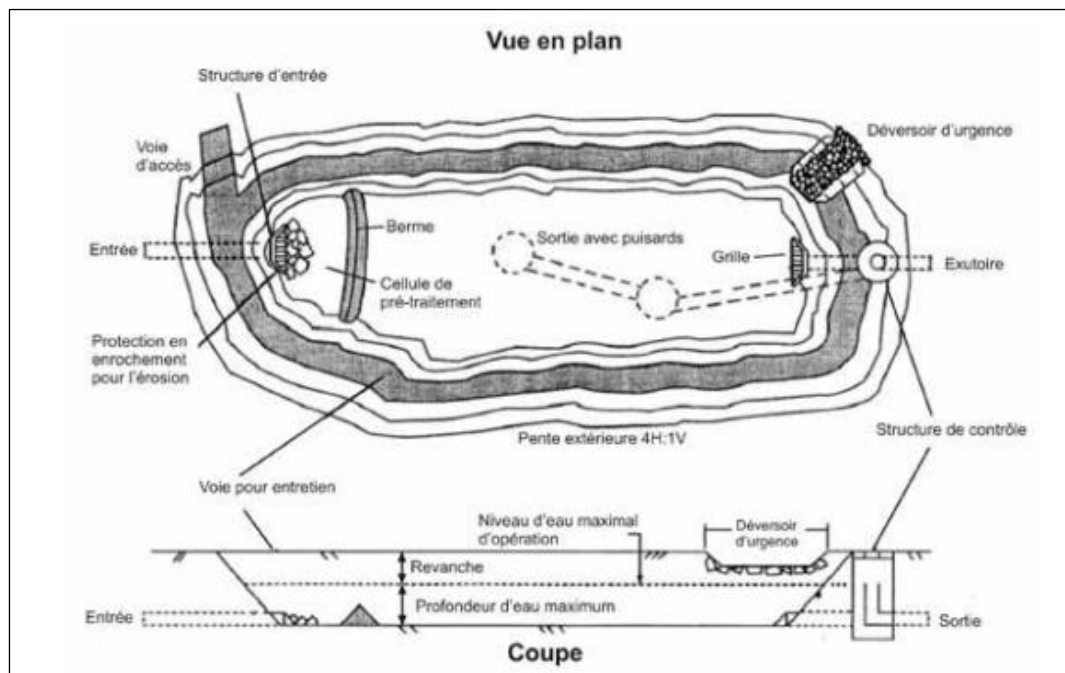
Vue en plan et section type d'un bassin de rétention avec retenue prolongée
